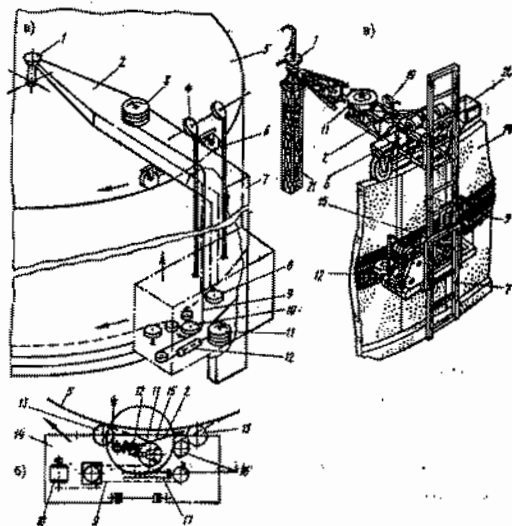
Навивка предварительно напряженной кольцевой арматуры на стены цилиндрических сооружений: 1 - ось вращения; 2 - стрела; 3 - бухтодержатель; 4 - лебедка; 5 - стена сооружения; 6 - верхняя тележка; 7 - вертикальная рама; 8 - нижняя тележка; 9 - цепь; 10 - приводная звездочка; 11 - конический барабан; 12 - механизм торможения; 13 - ратки тележки; 14 - подвесная (нижняя) тележка с навивочным устройством; 15 - напрягаемая арматура; 16 - направляющие ролики; 17 - натяжное устройство; 18 - электродвигатель; 19 - станок для сращивания проаолоки; 20 - место машиниста; 21 - стойка
